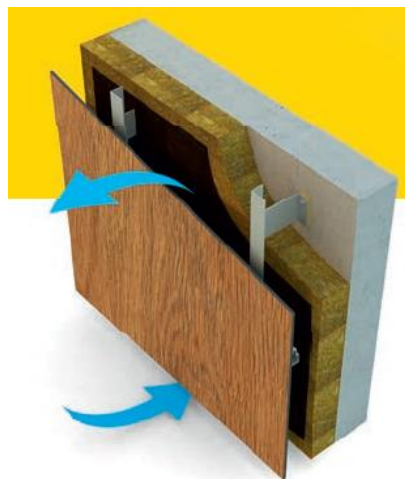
Fachada ventilada ([www.trespa.com](http://www.trespa.com))
